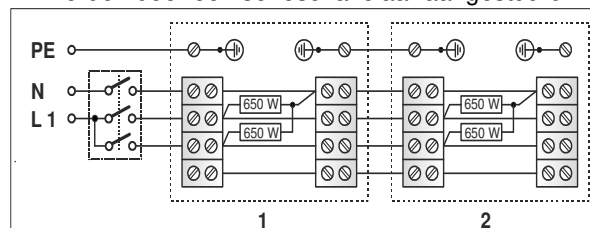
Voorbeeld voor 2 aangestuurde infraroodstralers. Spanningsvoorziening 1/N/PE 230V~.
